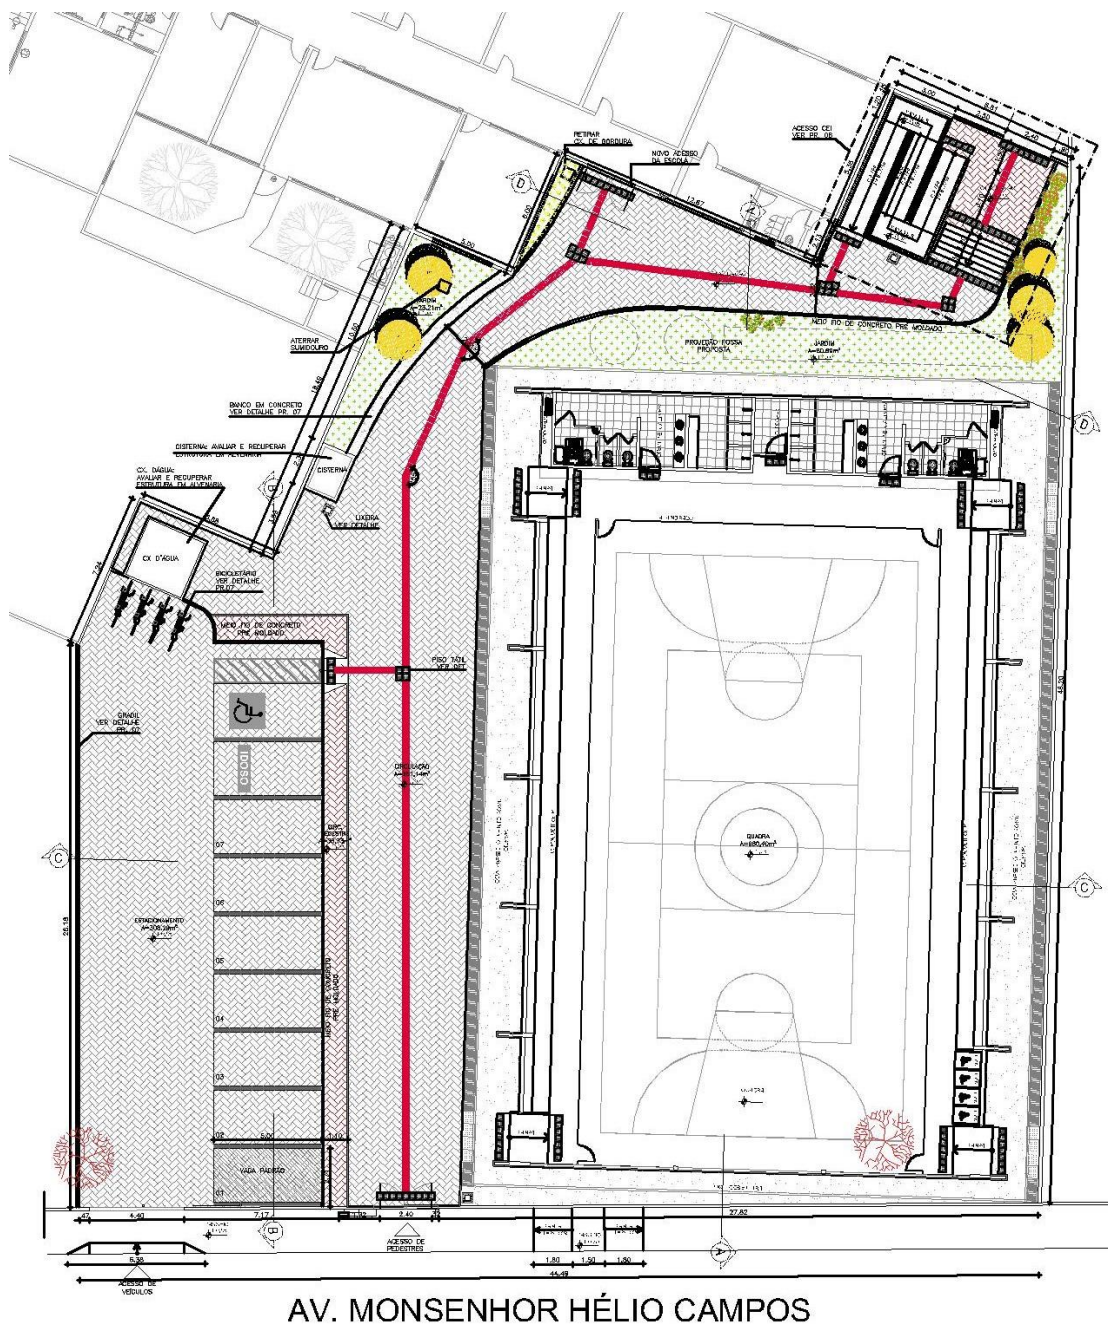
Planta de Implantação. Fonte: SEINF-COPROJ.
